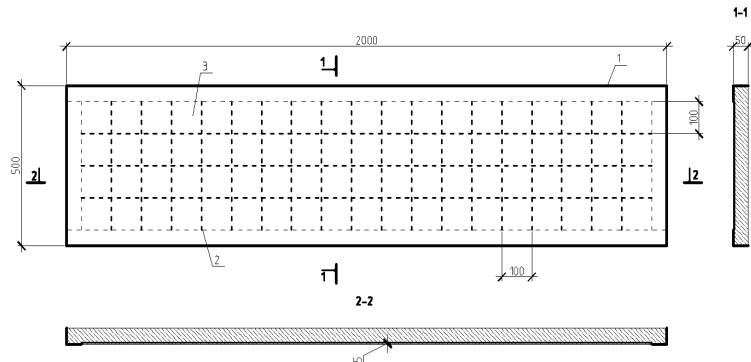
Дослідний зразок панелі перекриття ПП: 1 – кутик рівнополічковий 50×5; 2 – сітка арматурна (Вр-I, крок 100×100 мм); 3 – бетонний блок
